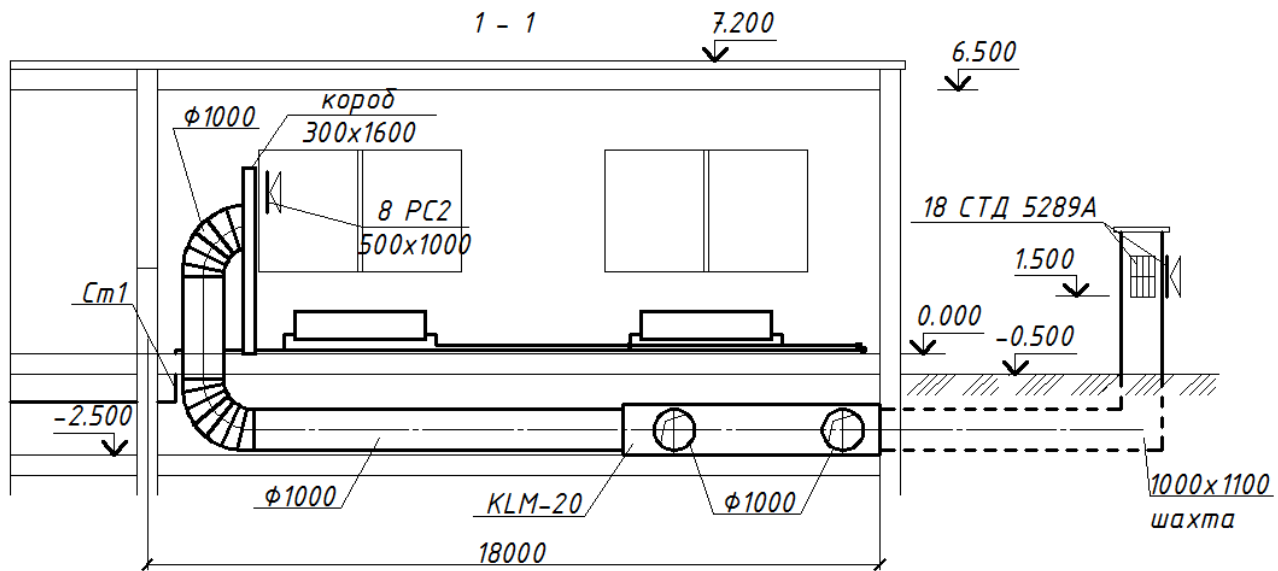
Разрез 1-1 с нанесением отопительно-вентиляционного оборудования
